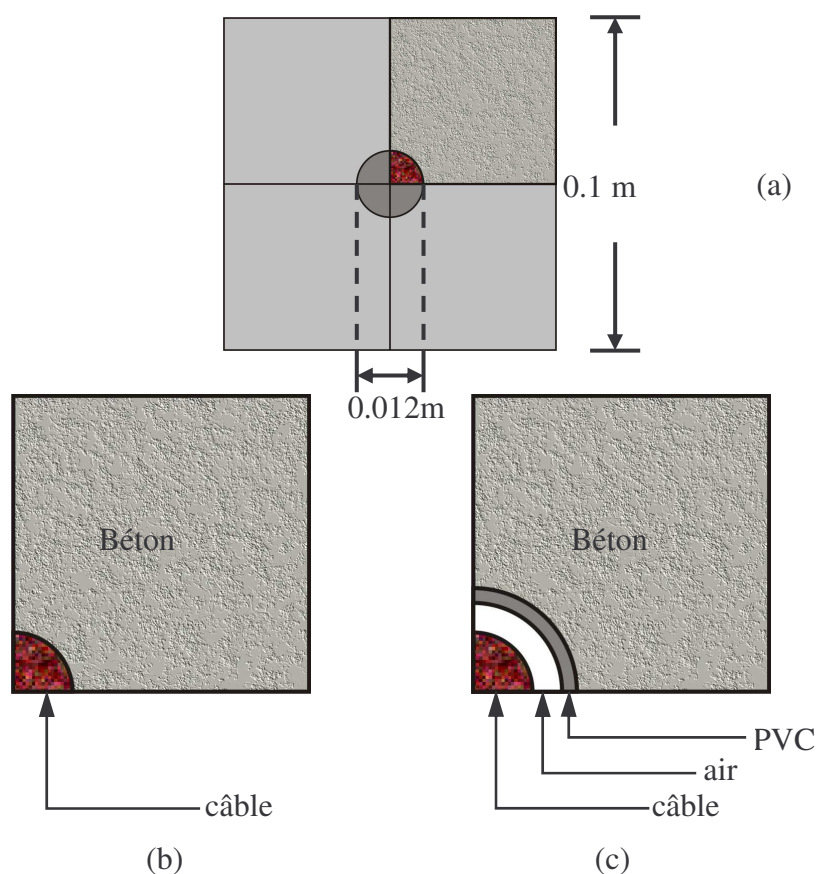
Coupe des spécimens (sain (b) et partie avec défaut (c))
